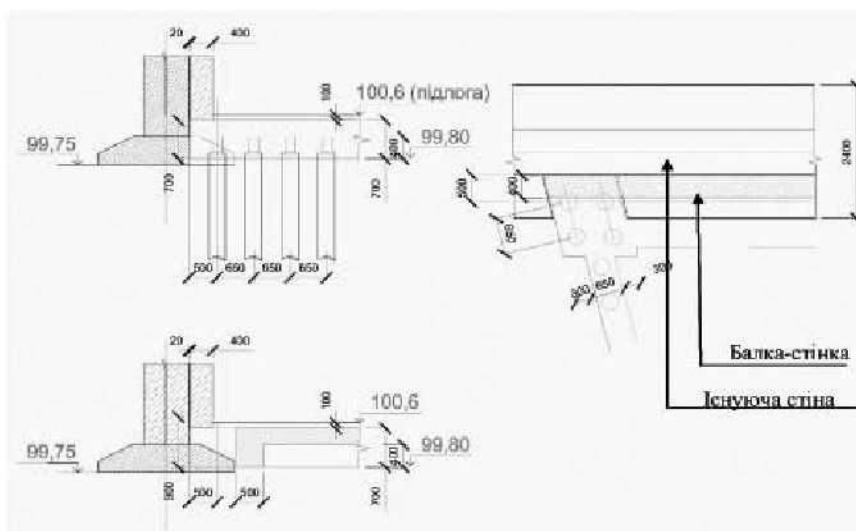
Вузли примикання захисної монолітної плити над метрополітеном до існуючих фундаментів будівлі.
